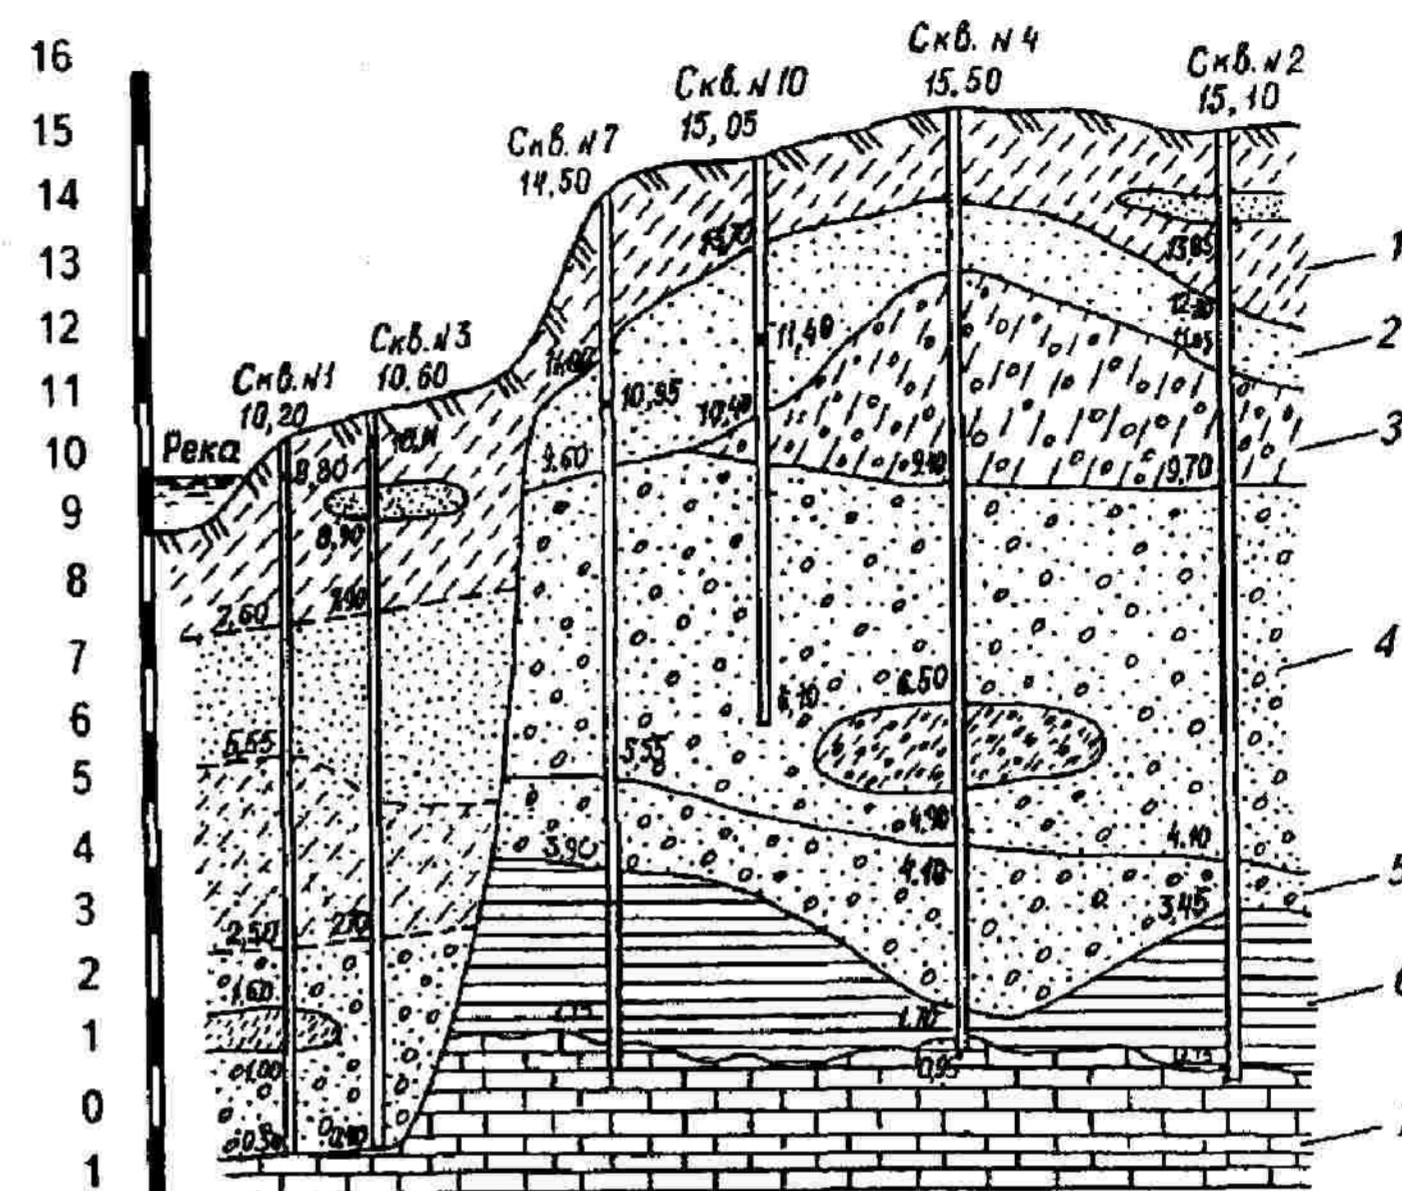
Геологический разрез строительной площадки (по Слюсаренко, 1982):
